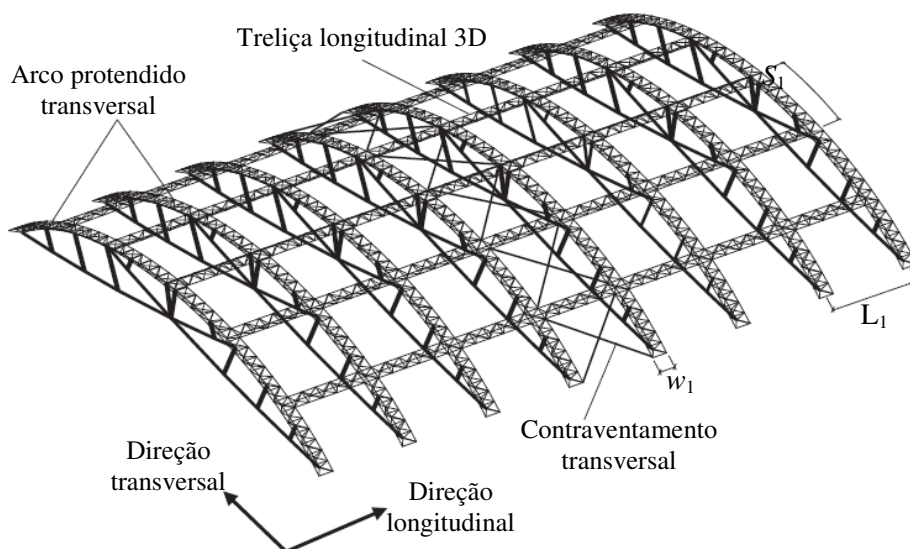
Configuração da estrutura em 3D completa (Yongjun et al., 2018).
